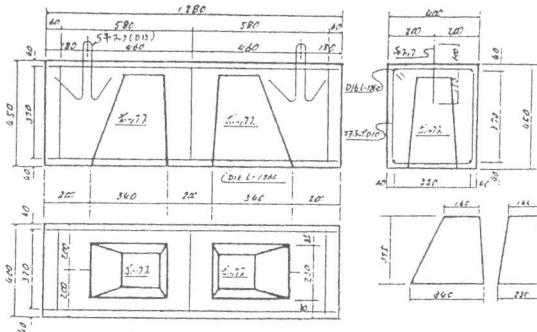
ボルトボックス模擬試験体の形状・寸法 (mm)
